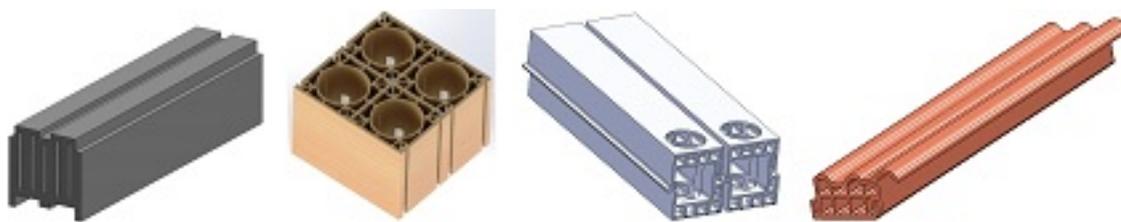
Отдельные элементы универсального набора (слева-направо: фундаментный блок, рядовой стеновой блок, балка перекрытия, кровельная плита)
